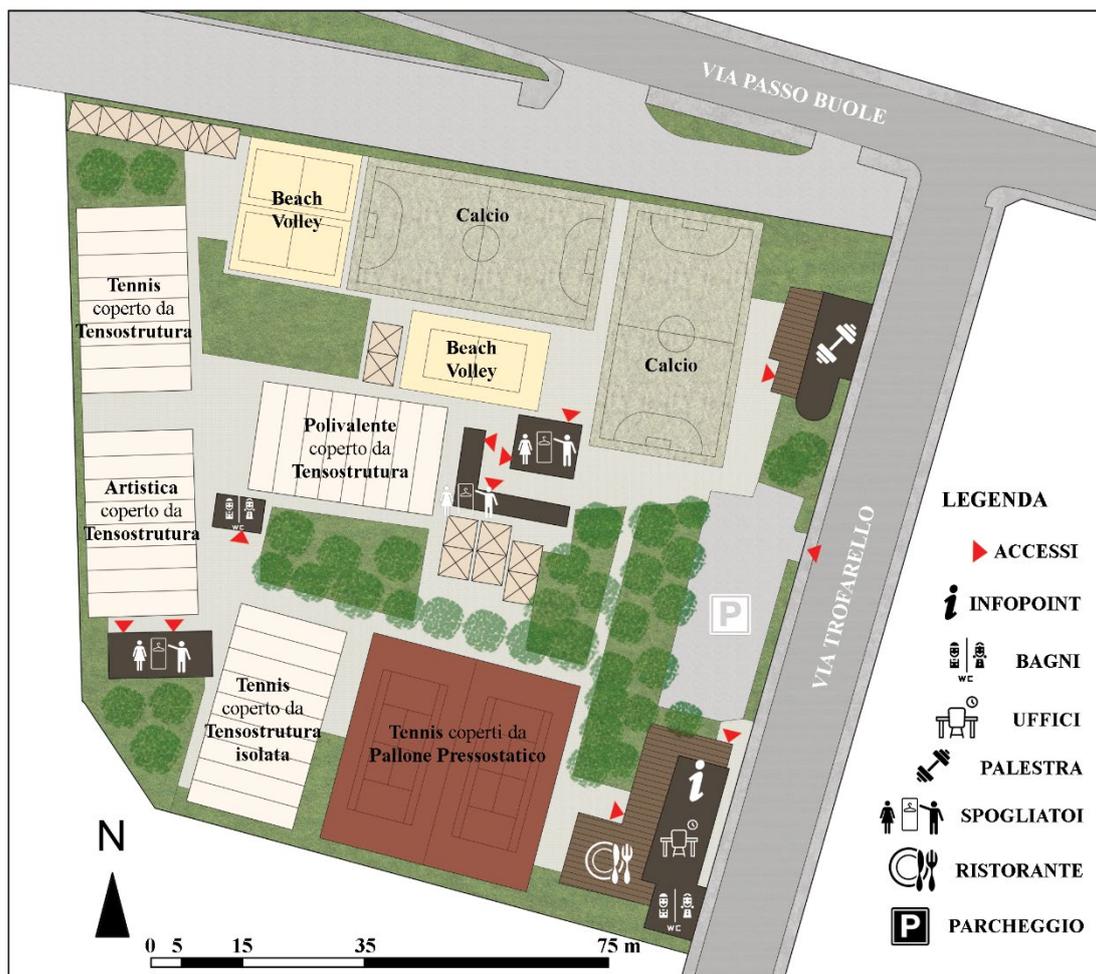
Rielaborazione grafica personale dell'impianto planimetrico del centro sportivo preso in esame di proprietà dell'azienda "CH4 Sporting Club"
